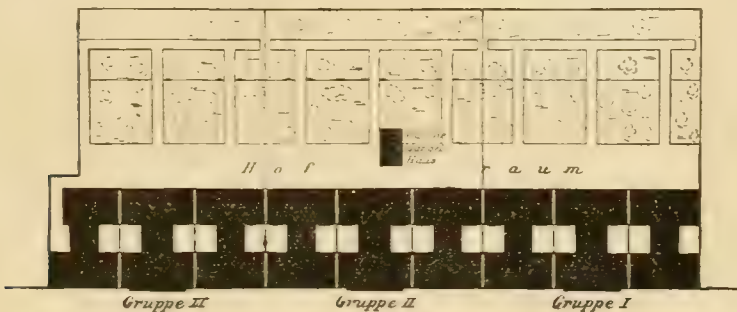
Häusergruppe des gemeinnützigen Bauvereins zu Dresden. Lageplan.
